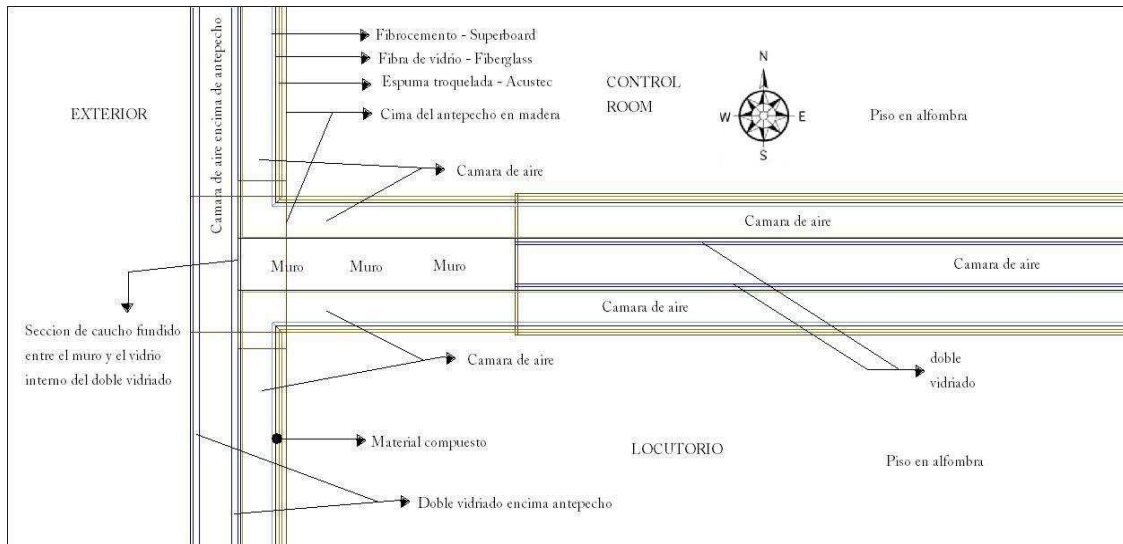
DETALLE DEL MURO QUE SEPARA EL CONTROL ROOM DEL LOCUTORIO
